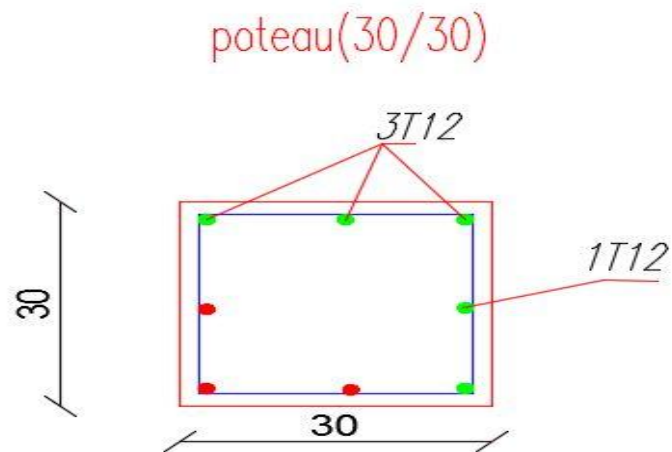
Coupe de ferrailage des poteaux 30×30 cm²
